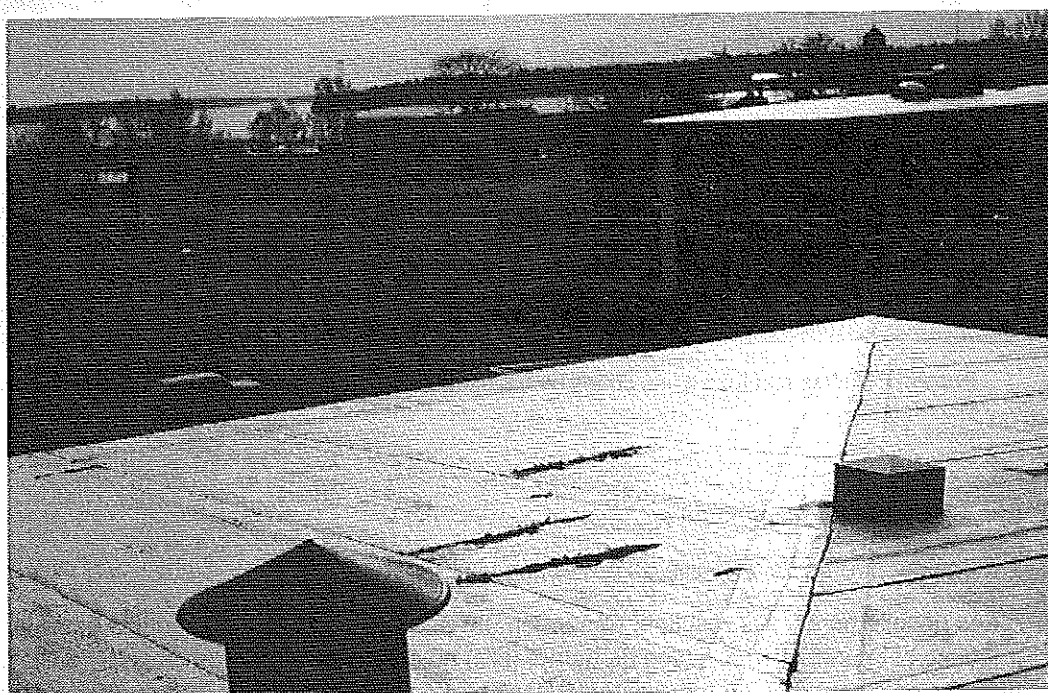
Arrachement de l'autoprotection métallique sur une toiture en Suède située dans une zone de lacs (visibles à l'horizon). Action des oiseaux marins (Uppsala - Nord de Stockholm). © J. Putatti
